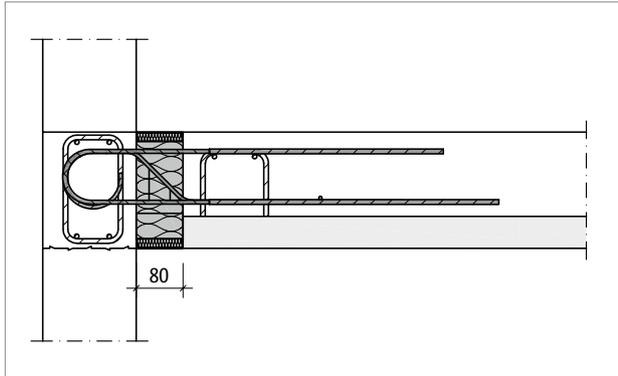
Schöck Rutherma® T type DF : distance minimale par rapport à la façade (valable également pour Schöck Rutherma® T type DF-S)
